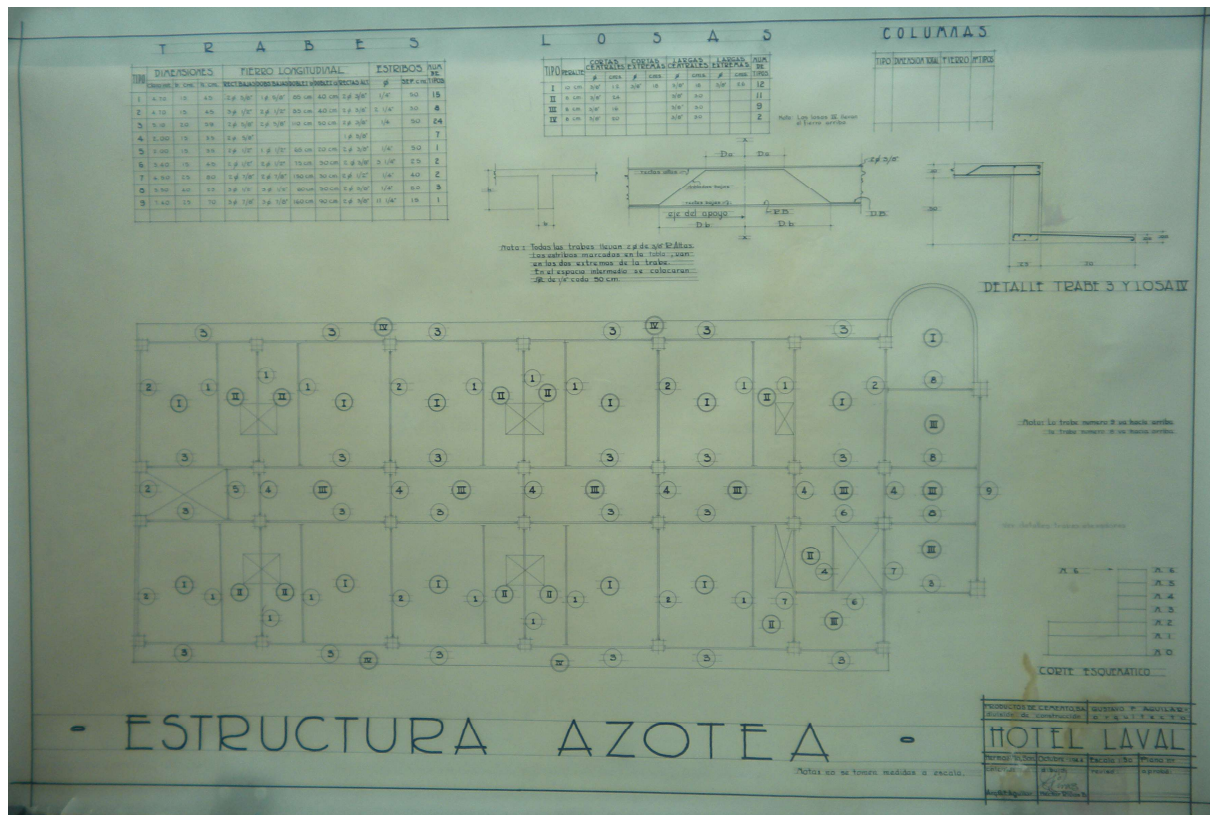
Plano de la estructura de la azotea del hotel Laval, se observan los cálculos de traves, losas y columnas realizados por el arquitecto Gustavo F. Aguilar Beltrán; además, en el cuadro de datos él aparece como calculista.
